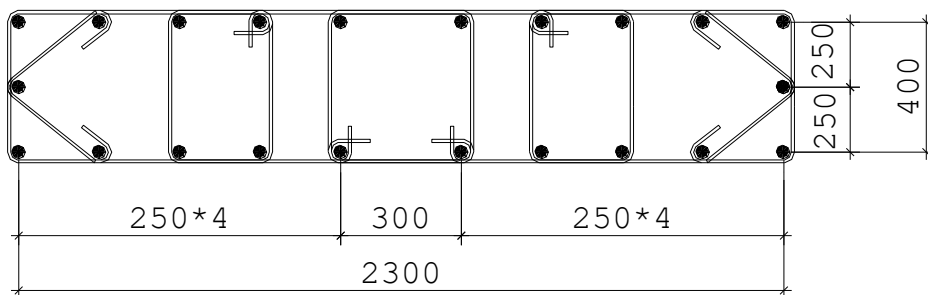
Армвання ферм на водонепроникних ґрунтах
